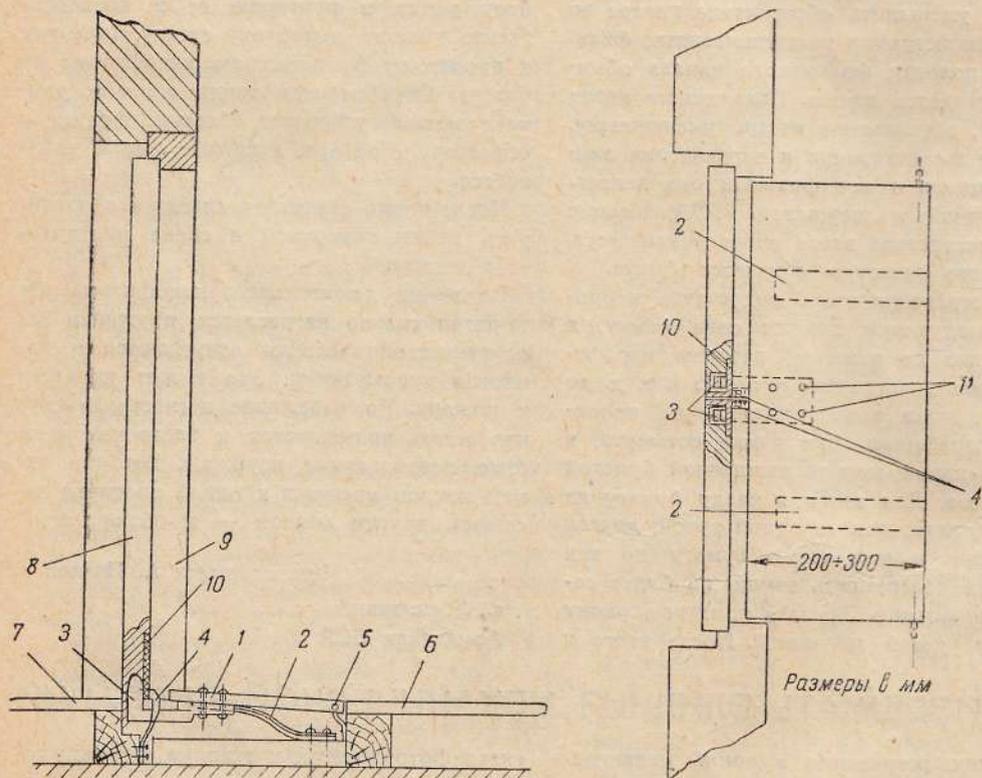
и 2. 1—доска трамплина (педаль); 2—пружина трамплина; 3—зуб дверной задержки; 4—защелка; 5—шарниры; 6—пол зрительного зала; 7—пол коридора; 8—дверь; 9—лудка; 10—металлические накладки; 11—болты
